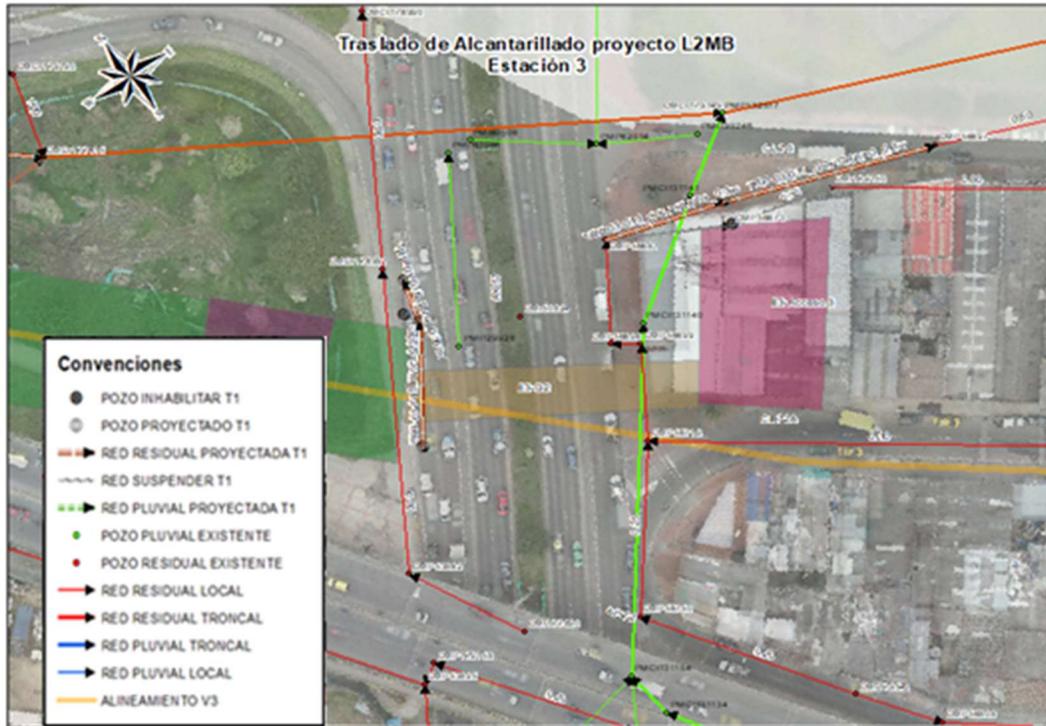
Traslado redes de alcantarillado Estación 3 Calle 72 Carrera 58A costado Oriente
